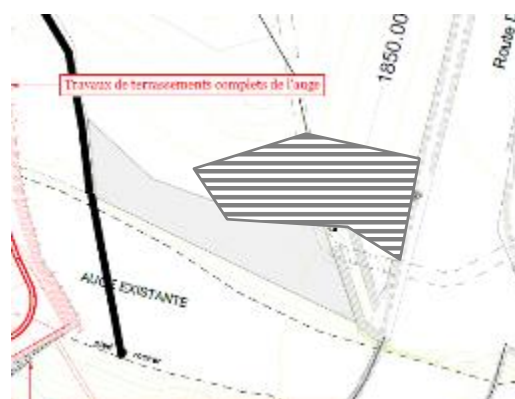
Implantation de la rampe d'accès temporaire dans la retenue
